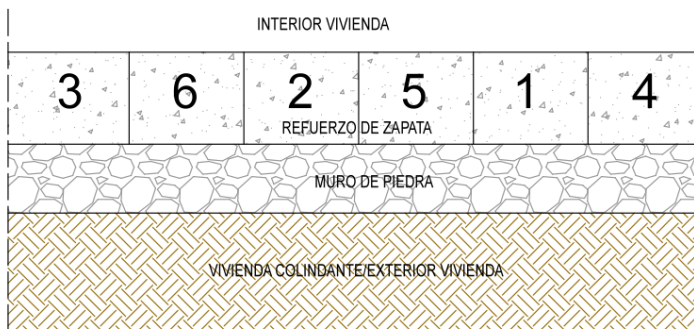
Fase de ejecución del refuerzo de cimentación. Fuente propia.
